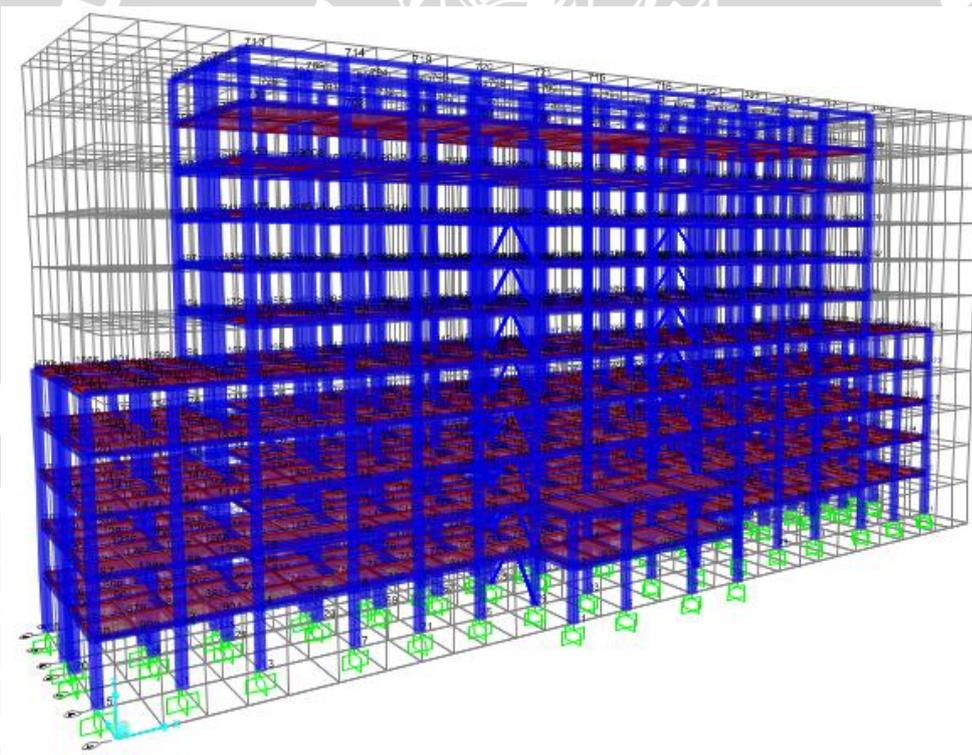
Pemodelan Struktur Alternatif dengan Single Brace (Tipe B)
